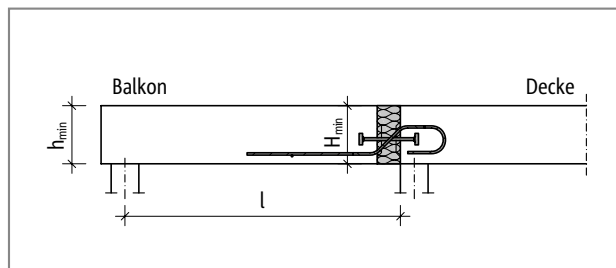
Schöck Isokorb® Typ QP20S und QP50M: Statisches System
